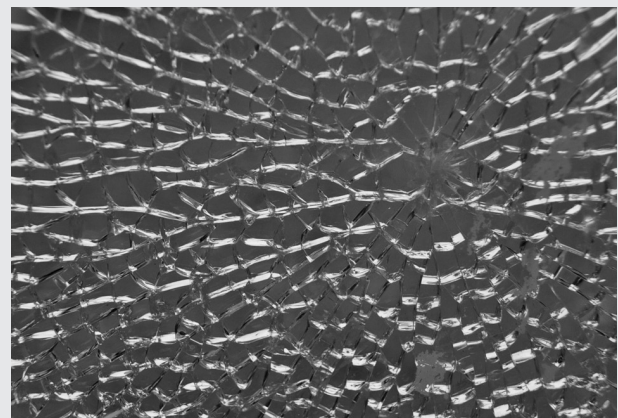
Bruchbild ESG; Quelle: <https://www.baunetzwissen.de/glossar/h/heisslagerungstest-51341/gallery-1/1> (zuletzt abgefragt am 12.02.2018).
